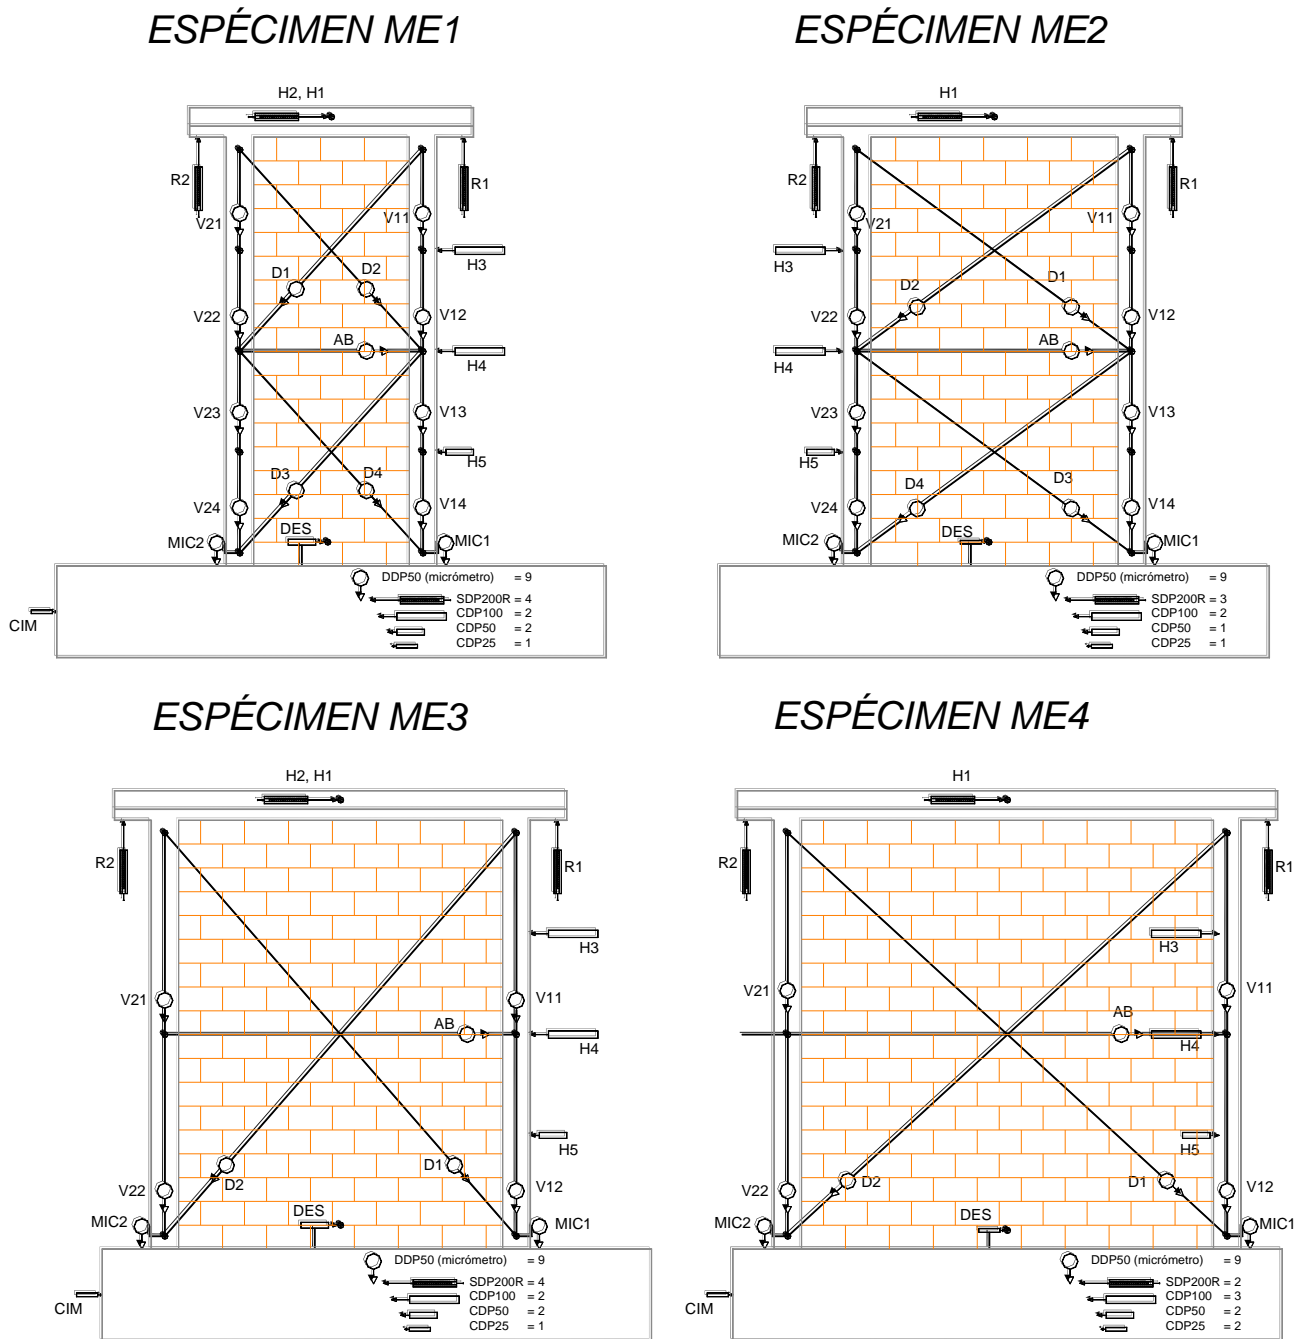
Arreglos generales de instrumentación en los cuatro muros. (Flores, et al. 2008)
